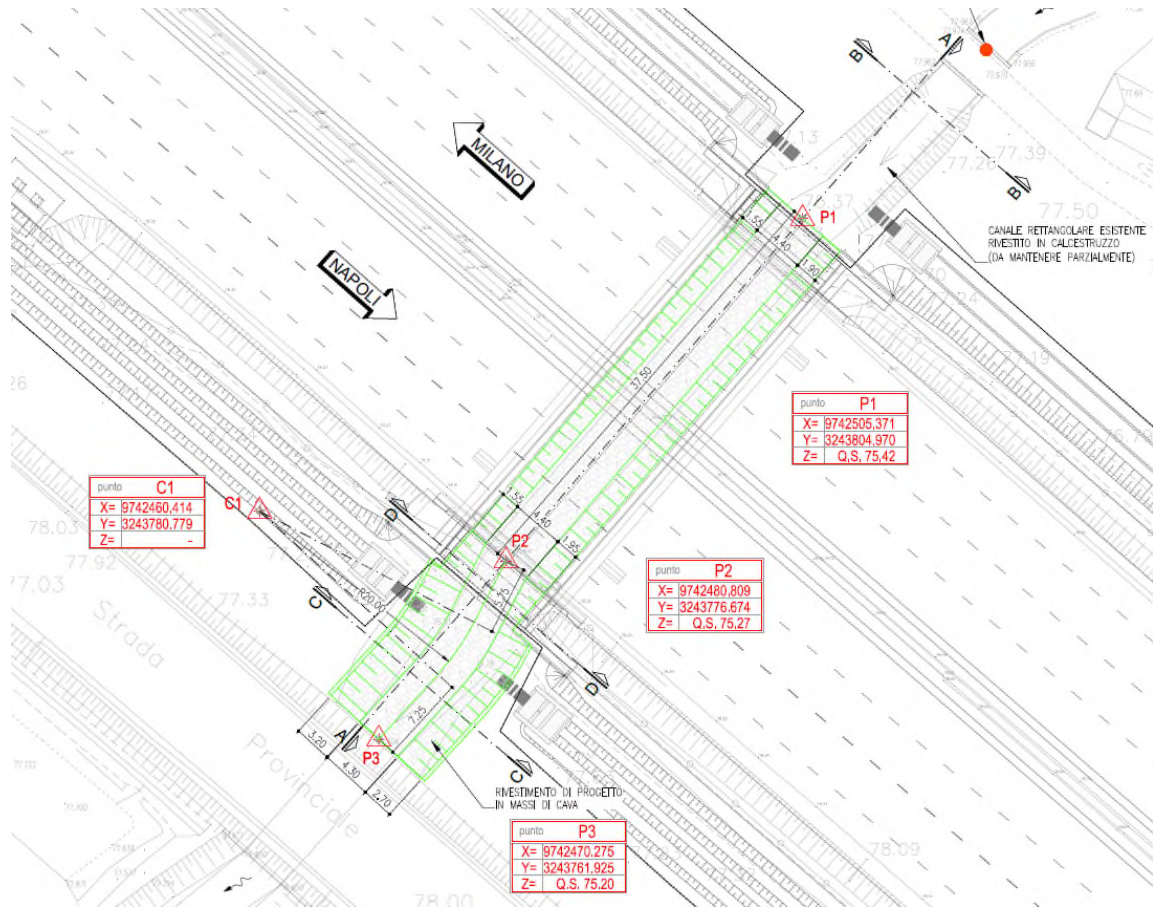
Planimetria della sistemazione spondale della Roggia Barbavara
